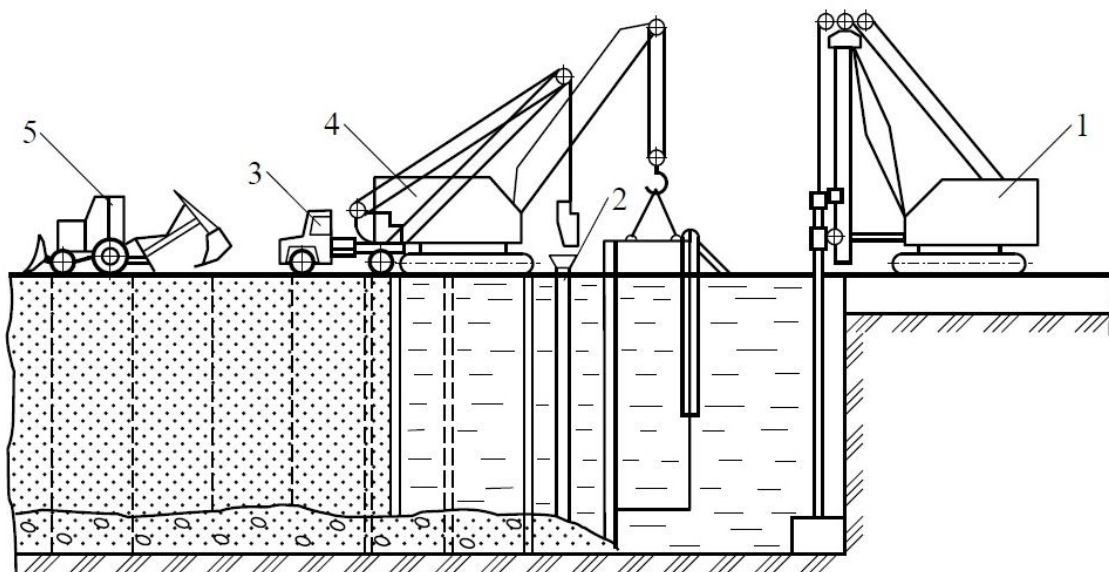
Технологічна схема методу «Стіна в ґрунті»: 1 – штанговий екскаватор; 2 – бетонолитна труба; 3 – автокран для укладання бетону; 4 – кран для монтажу панелей; 5 – механізм для зворотного засипання
